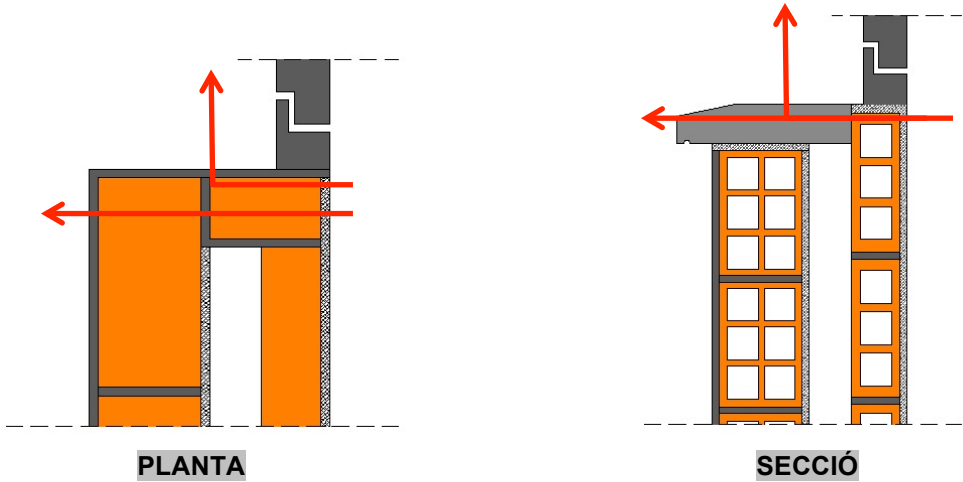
Detalls constructius trobada brancal amb fusteria exterior i trobada ampit amb fusteria exterior (Font: Elaboració pròpia)
